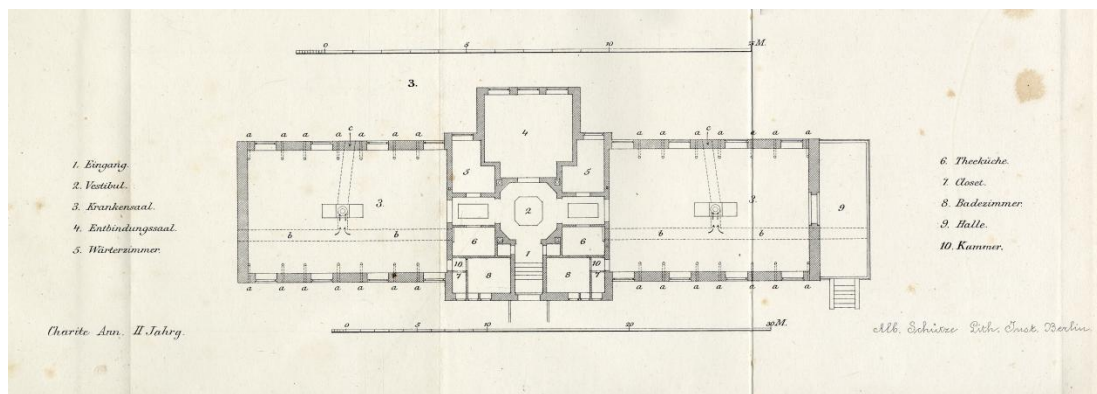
Grundriss geburtshilflicher Pavillon (Mehlhausen 1877 Tafel IV)
